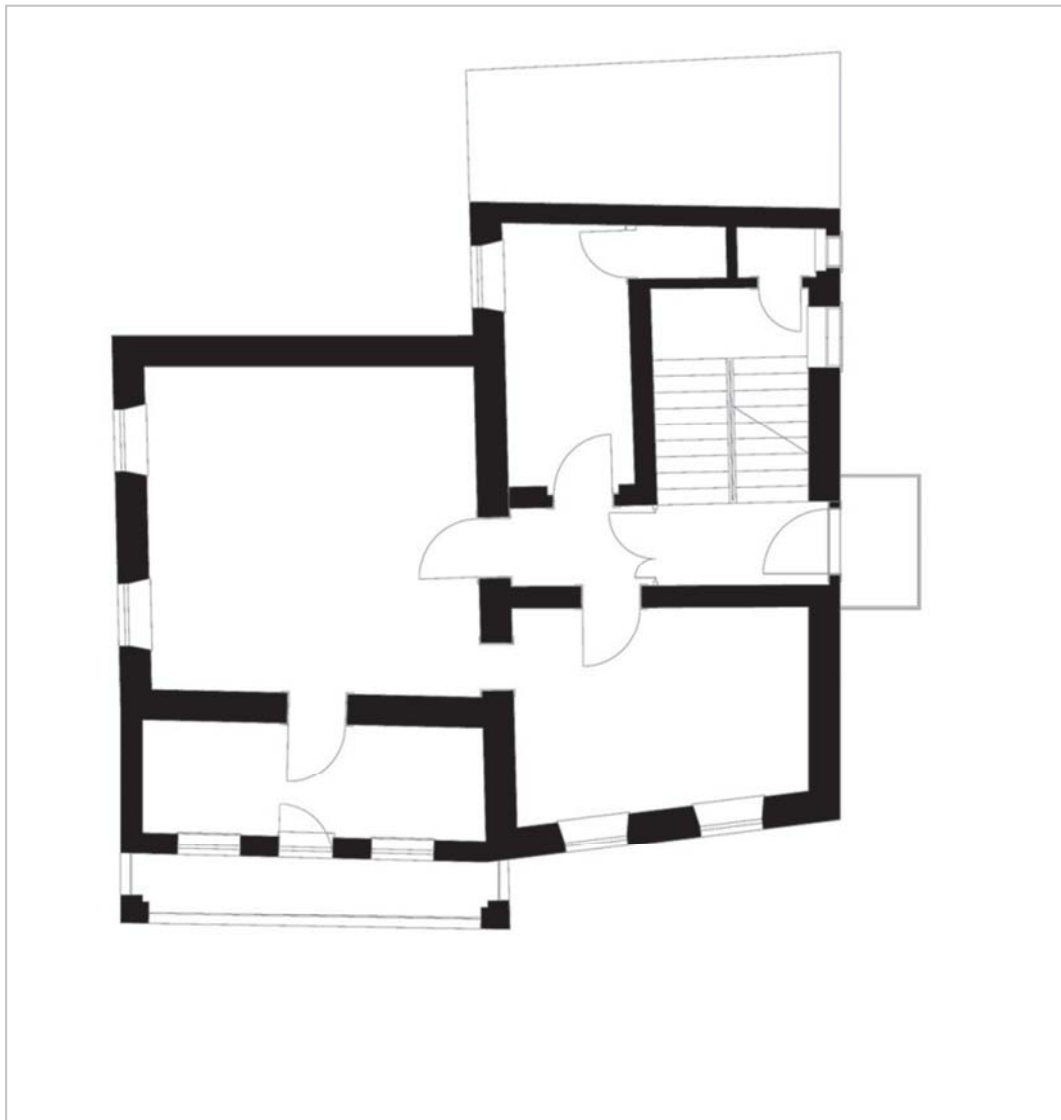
Grundriss des ersten Obergeschoßes, 2017
